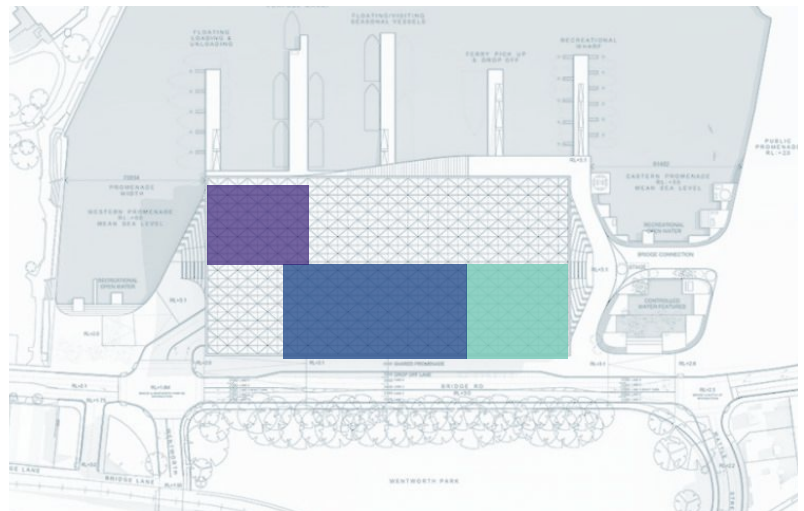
ESQUEMA SEGUNDO NIVEL THE PLAN, 3XN, 2020
